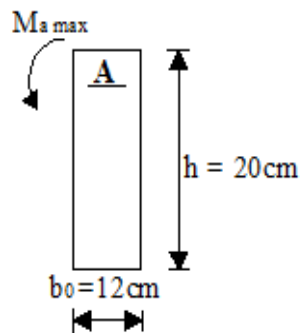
Coupe schématique de la poutrelle (appuis)
